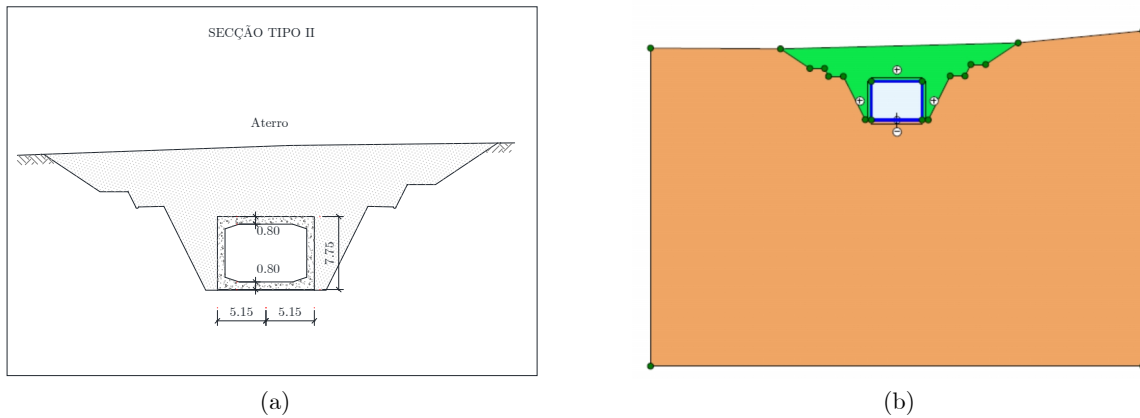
Cortes transversais: (a) Modelo 3 – corte transversal tipo; (b) Modelo estrutural executado no PLAXIS.
